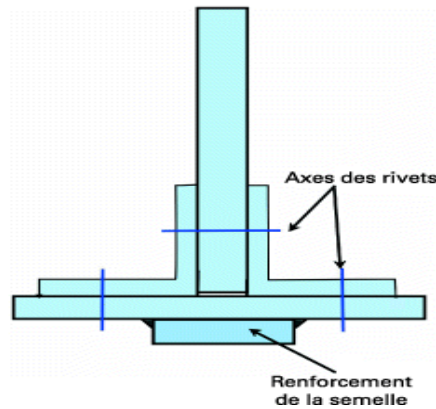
Exemple de renforcement par ajout de matière par soudure [9]
